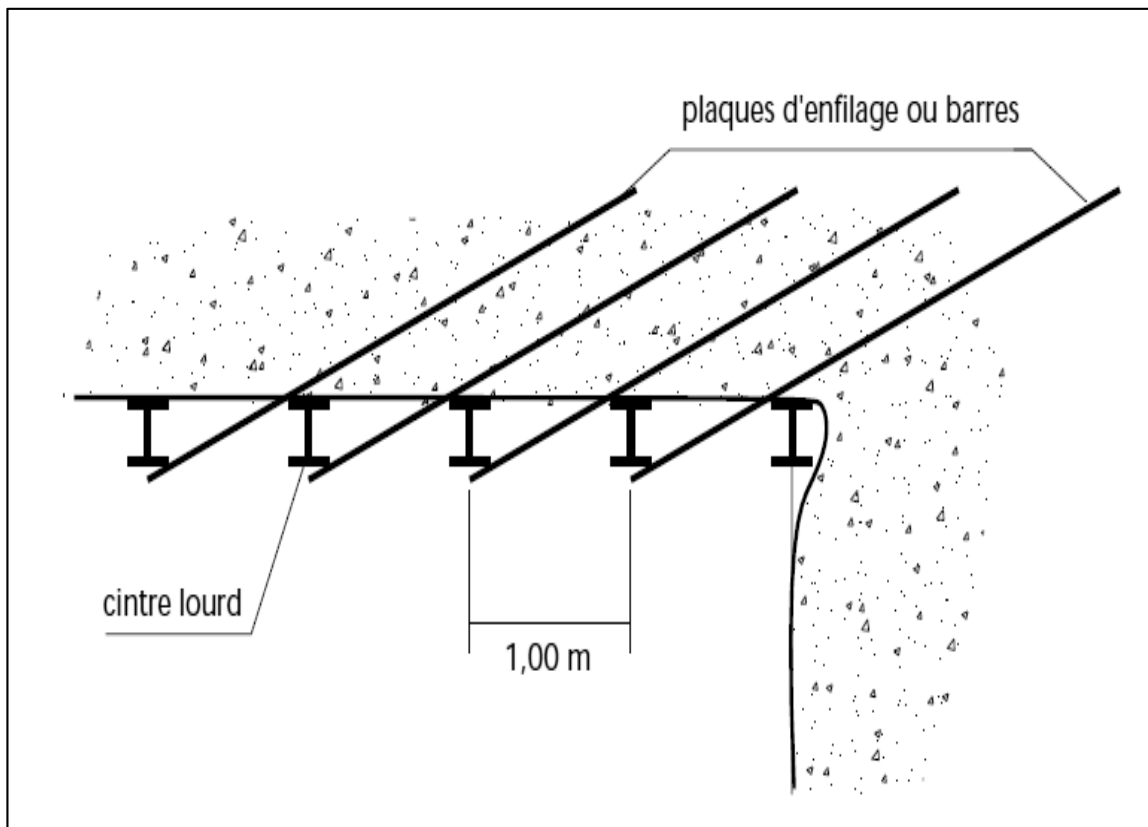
L'enfilage en calotte par plaques d'acier ou barres. [20]
